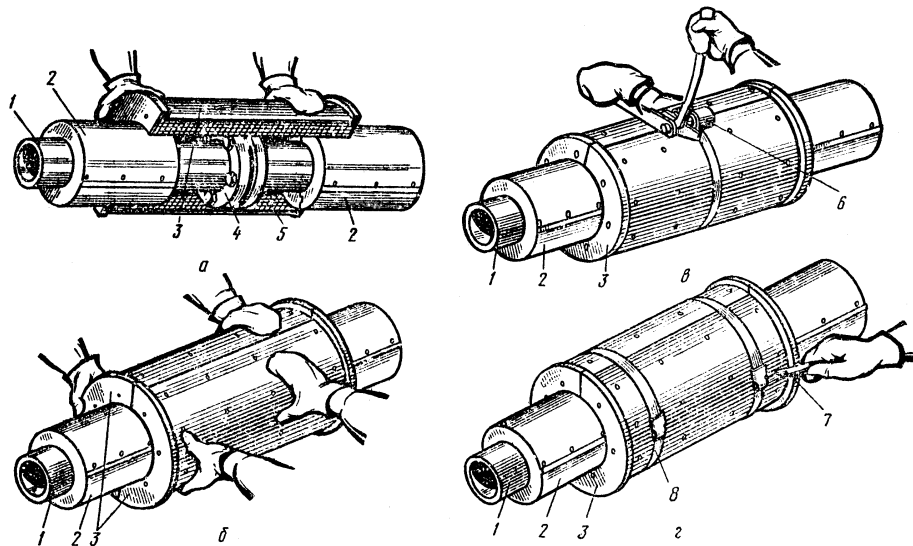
Монтаж збірних конструкцій на фланцевих з'єднаннях трубопроводів: а – встановлення першого півфутляра; б – встановлення другого півфутляра; в – стягування півфутлярів; г – установлення й закріплення бандажів; 1 – трубопровід; 2 – теплоізоляція трубопроводу; 3 – півфутляри; 4 – фланцеве з'єднання; 5 – теплоізоляційний шар; 6 – стяжна машинка; 7 – ключ для стягування бандажів; 8 – бандаж
